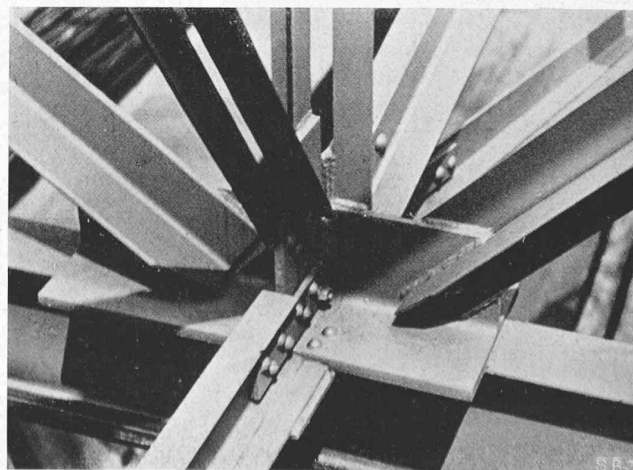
Knotenpunkt mit Werkstatt-Schweissung und Montage-Nietung.
